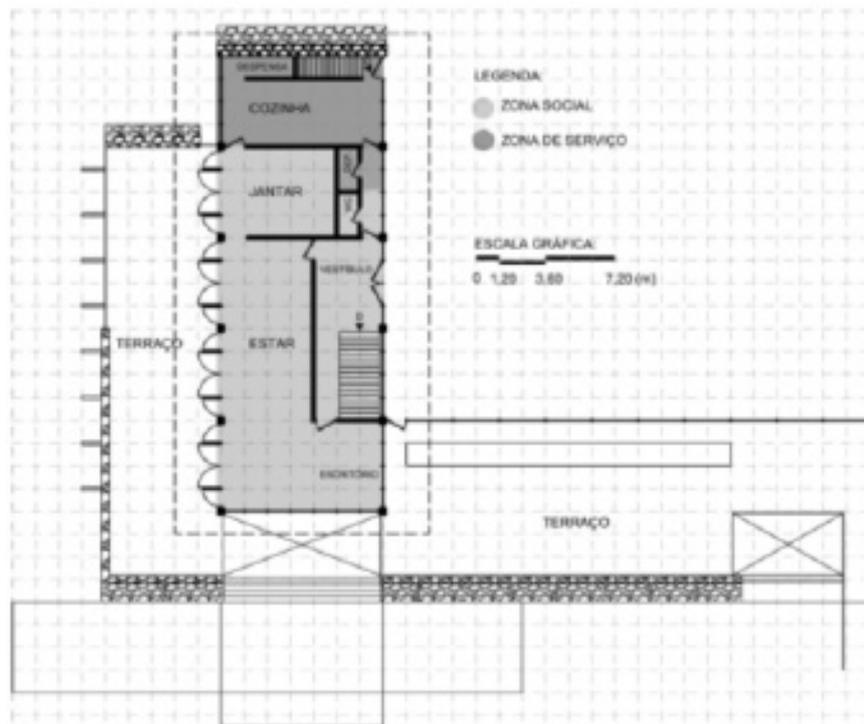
Planta Baixa pavimento superior da casa do arquiteto Sergio Bernardes redesenhada pelo autor.
